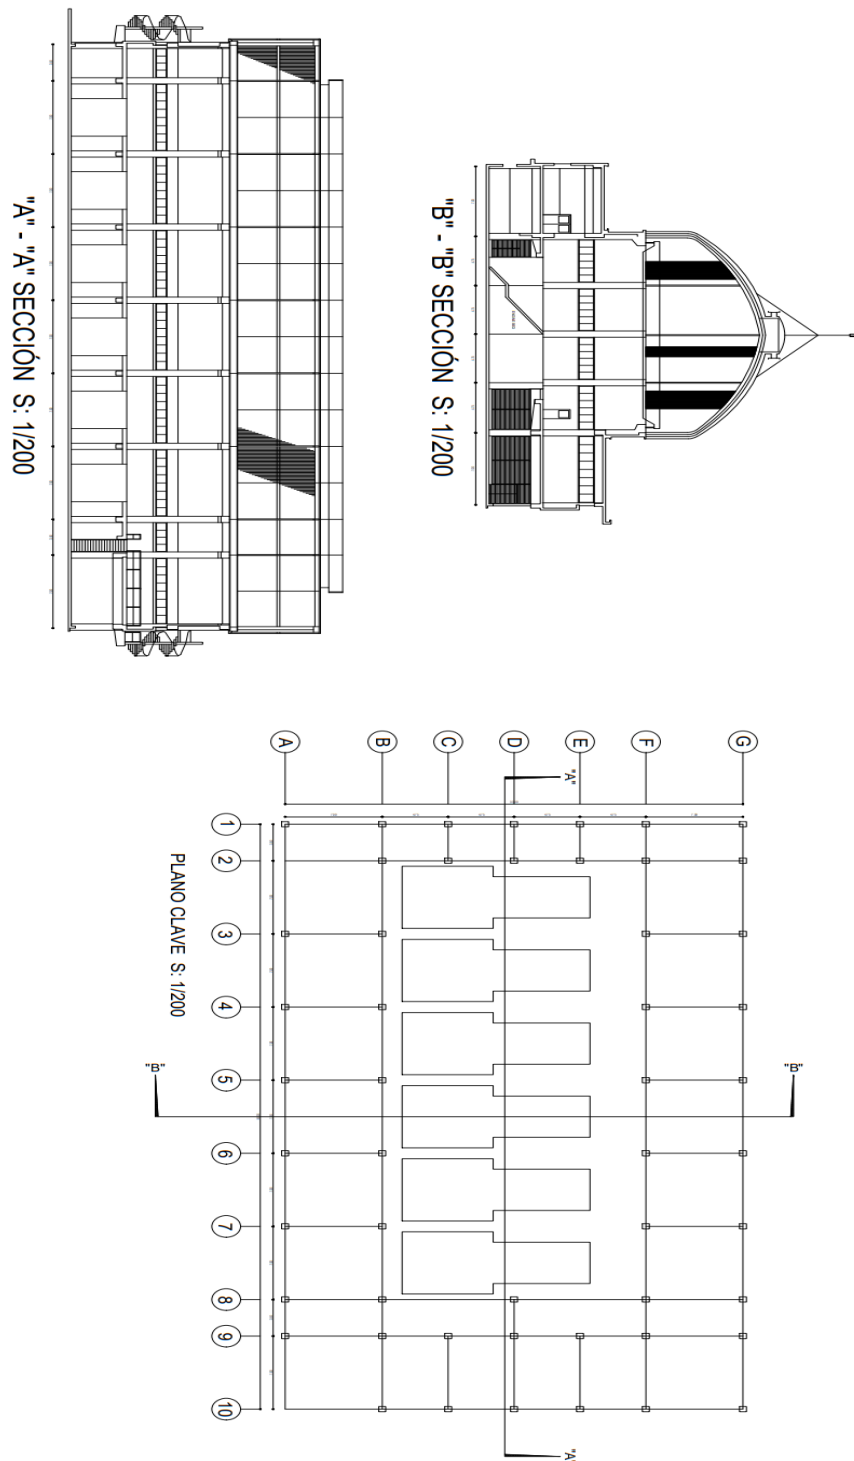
planos elaborados de los cortes de las fachadas - AutoCAD
